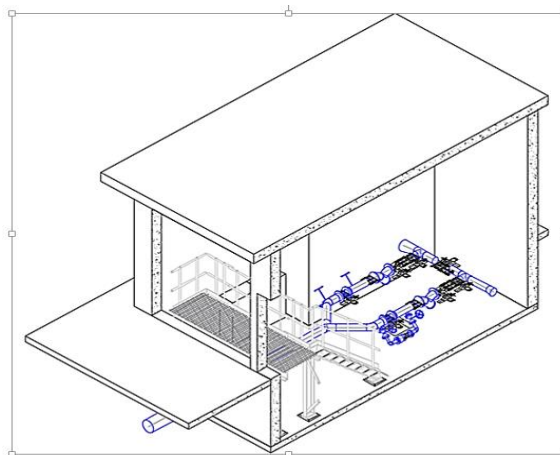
Configuración tipo de una Estructura de Control Vista en Planta
